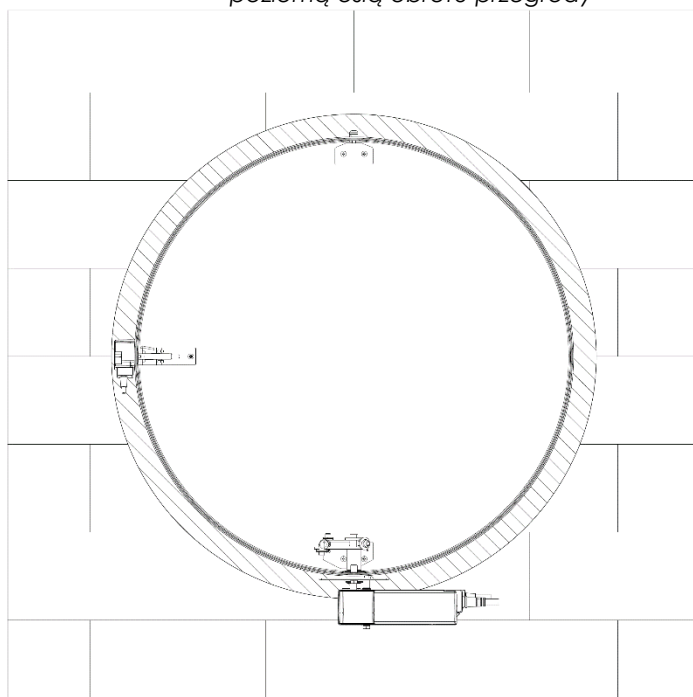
Sposób zabudowy kłap odcinających KTS w konstrukcjach stropowych
